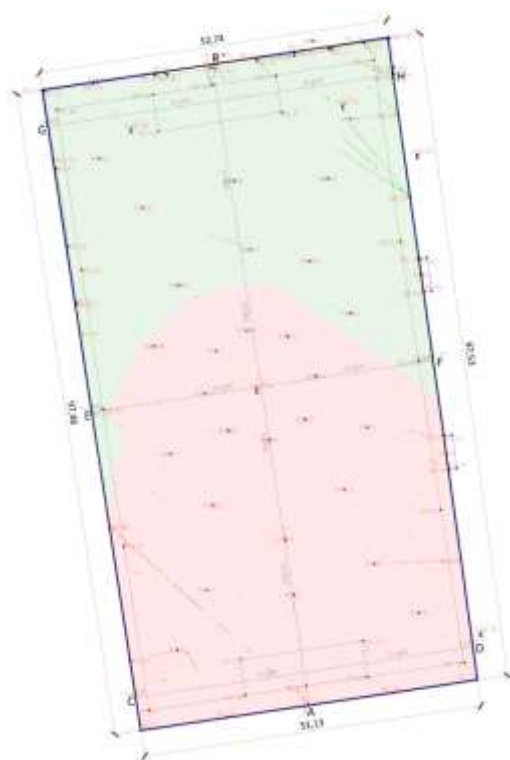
Planta de levantamento de cotas atuais e de movimento de terras
